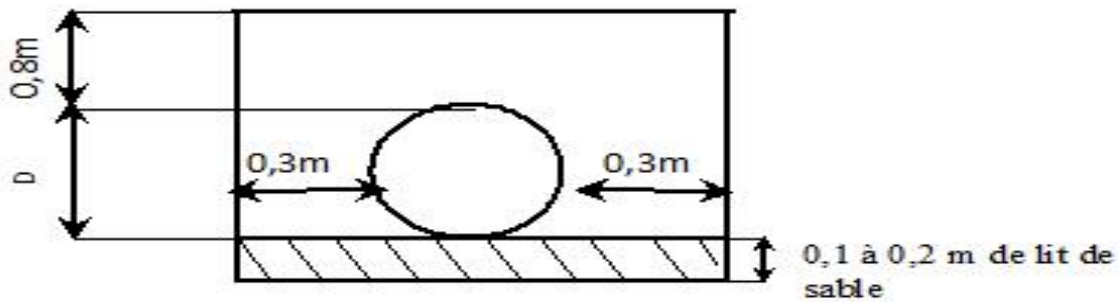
Coupe transversale de la Pose de Conduite.
